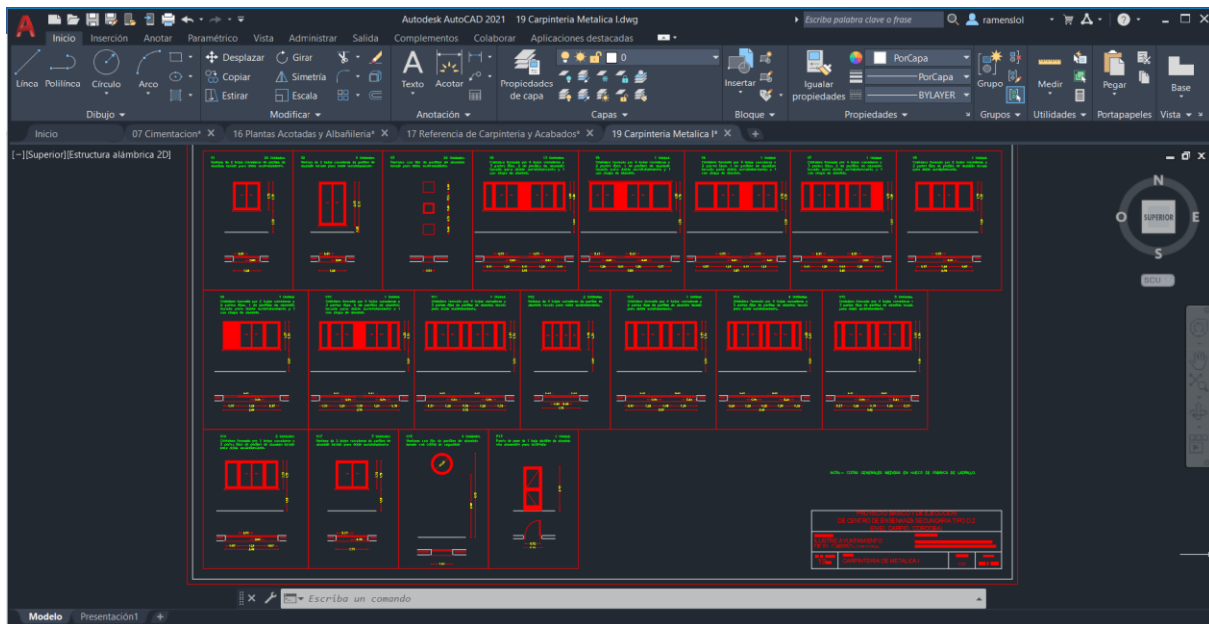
Plano de Carpintería metálica en Autocad del proyecto real
